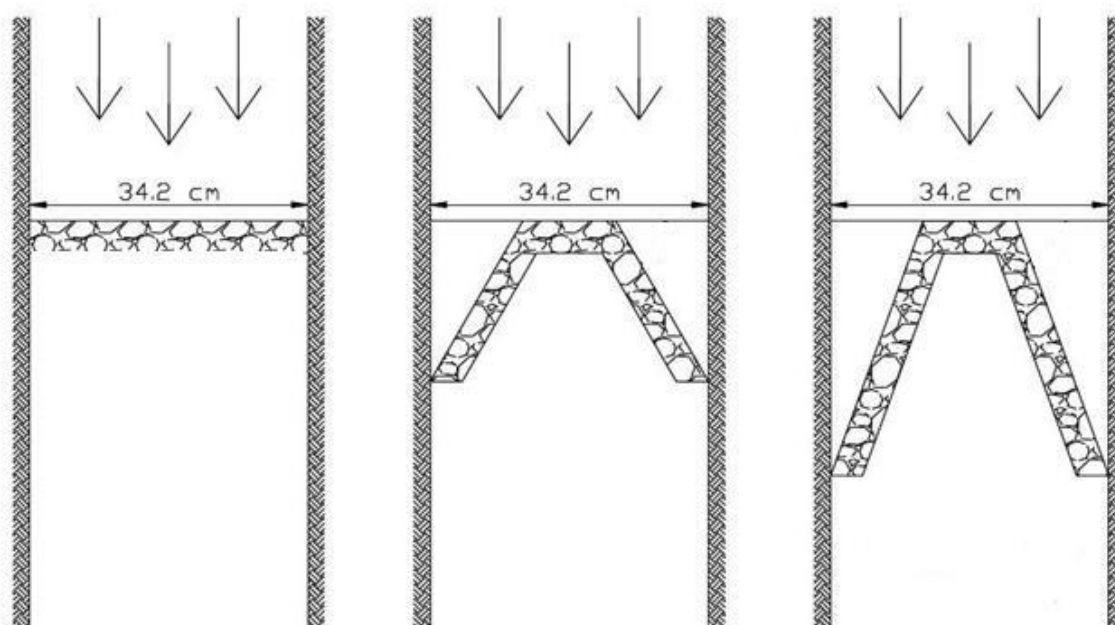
Vista in pianta delle strutture; da sinistra verso destra: lineare, trapezoidale corta, trapezoidale lunga
